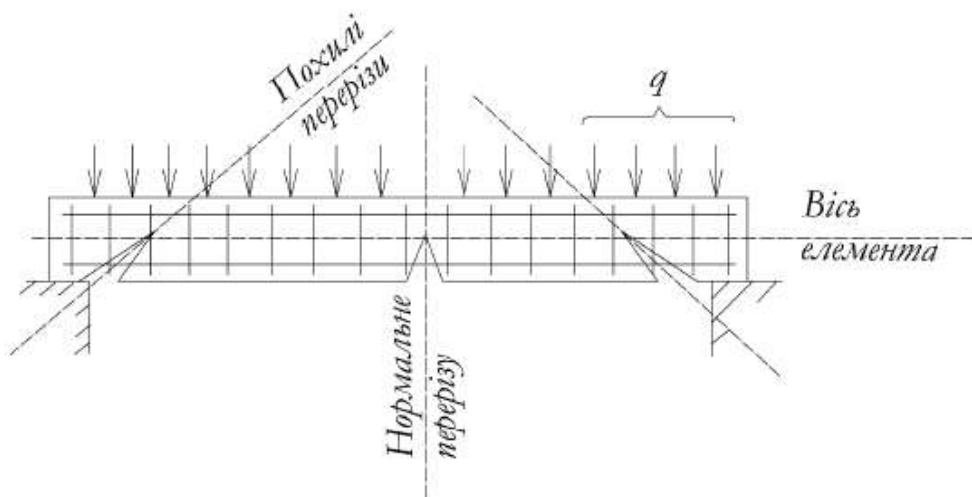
Руйнування балки по нормальному і похилому перерізу
